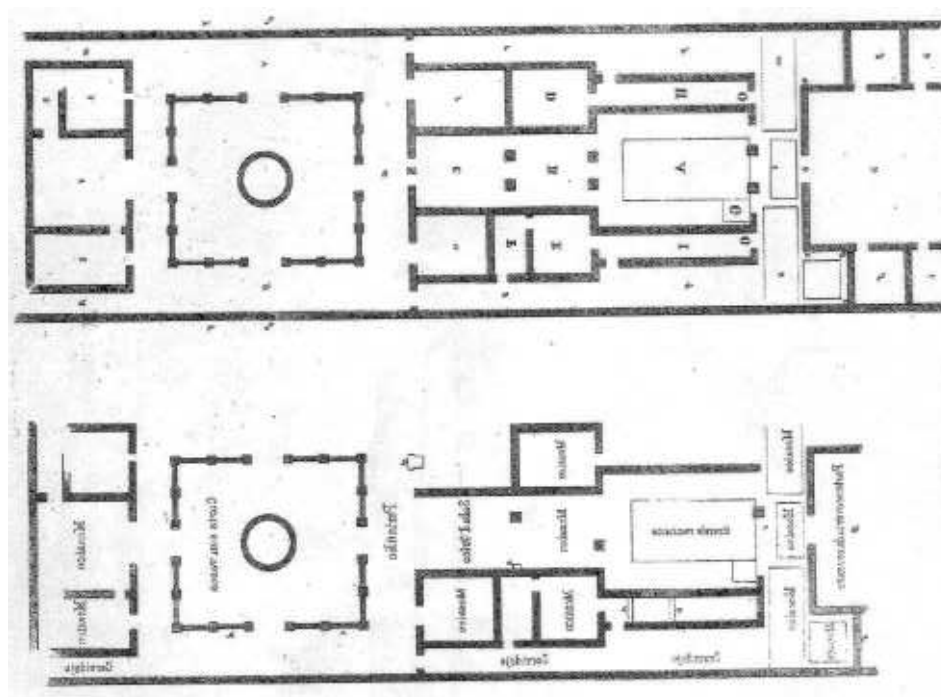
Planimetrie della Domus A disegnate dall'arch. G. B. F. Basile nel 1874. Sotto: lo stato di fatto, sopra: la ricostruzione planimetrica.
